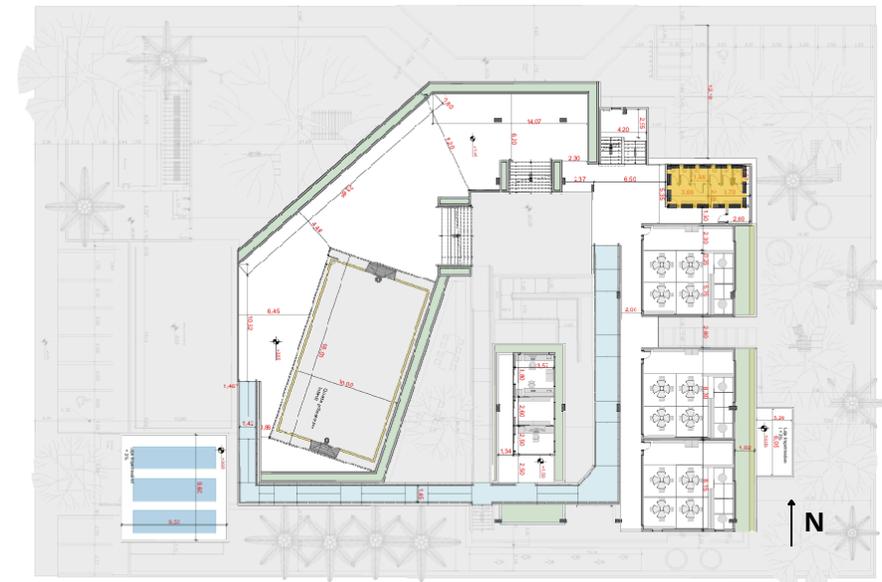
Planta baixa Pavimento Mezanino e Térreo +1
